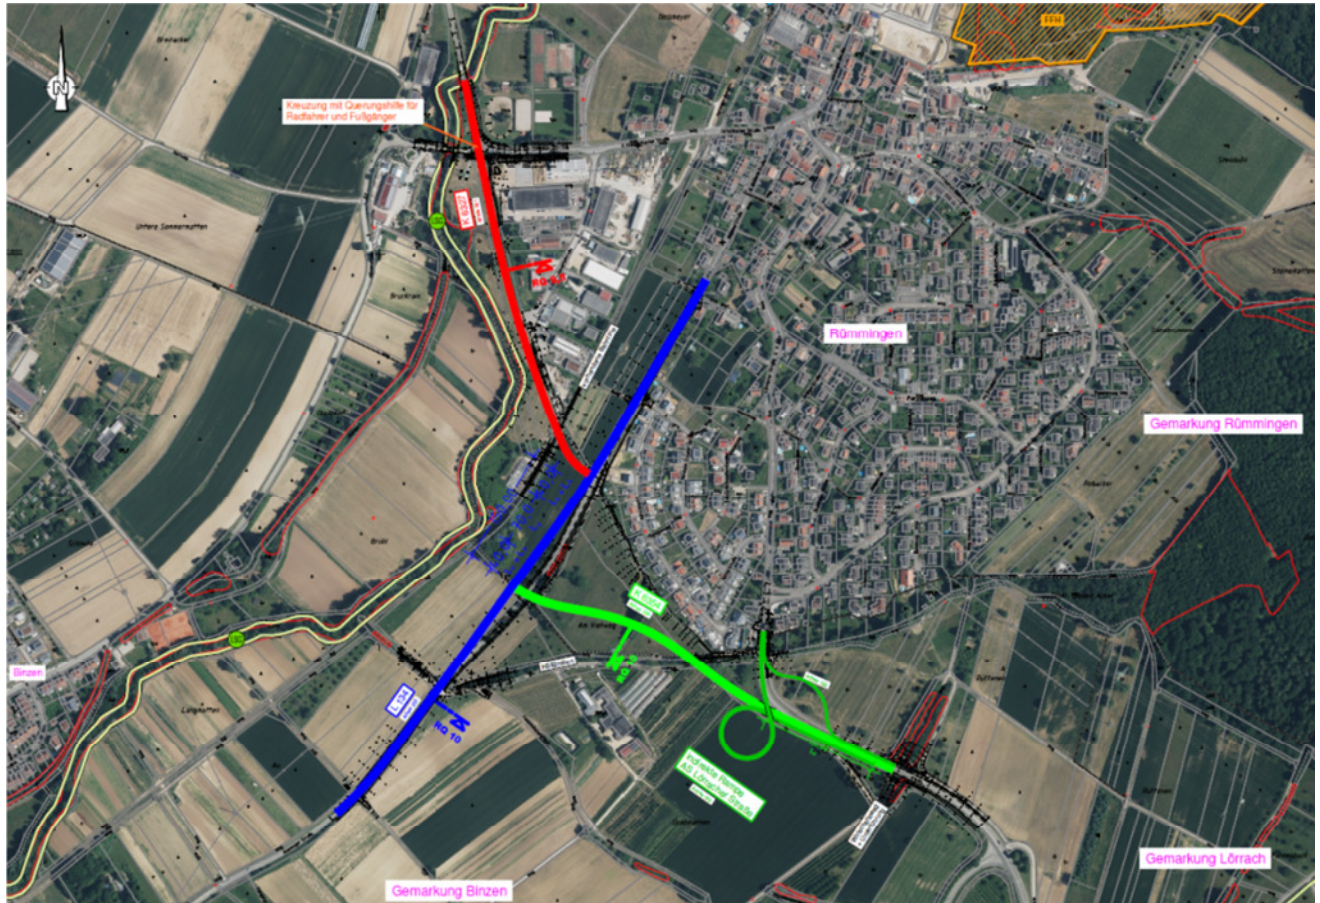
Übersichtslageplan – Linienführung Planfall 3
